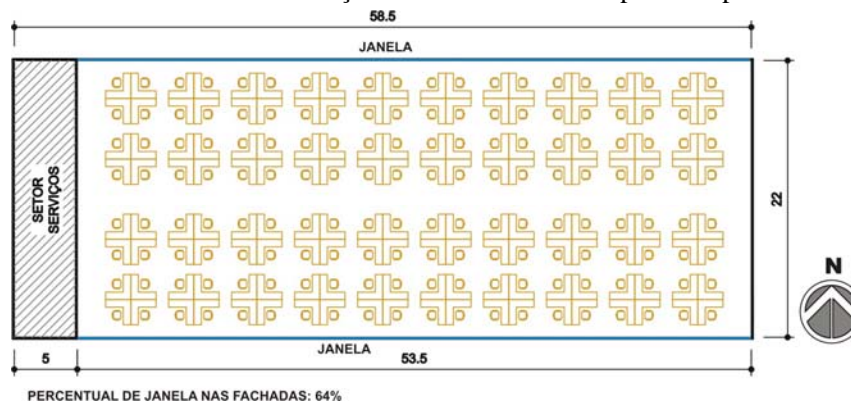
Planta baixa MODELO VIRTUAL de escritório com layout
